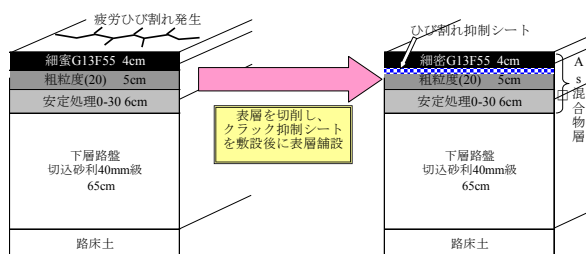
2-1 疲労ひび割れ補修方法概要図
